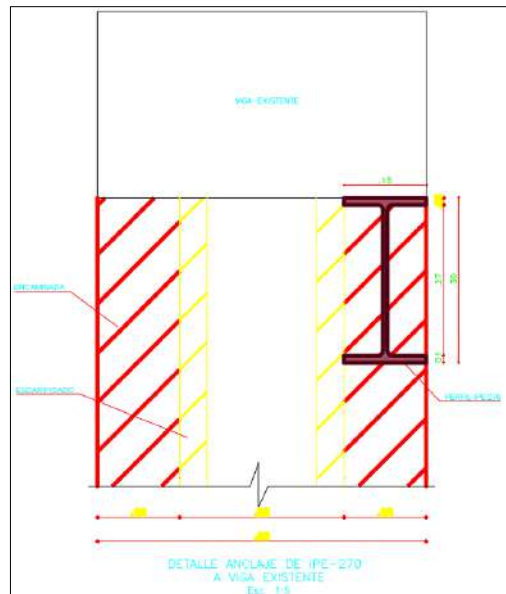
Esquema representativo del perfil metálico reforzando vigas y columnas de concreto.
